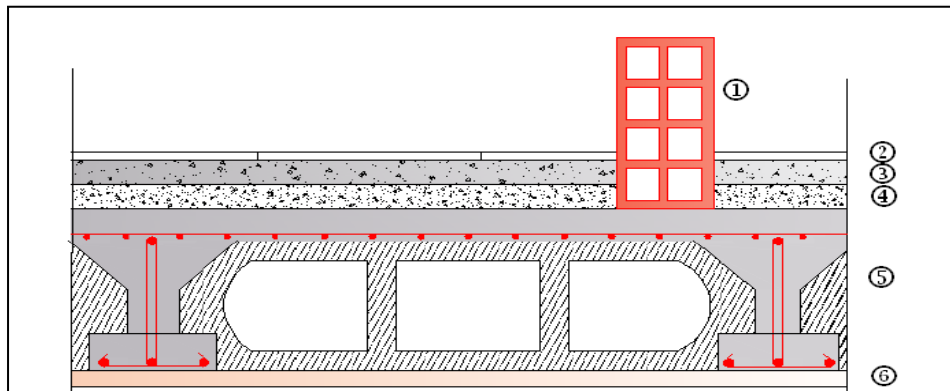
Coupe transversale au niveau de plancher étage courant.
